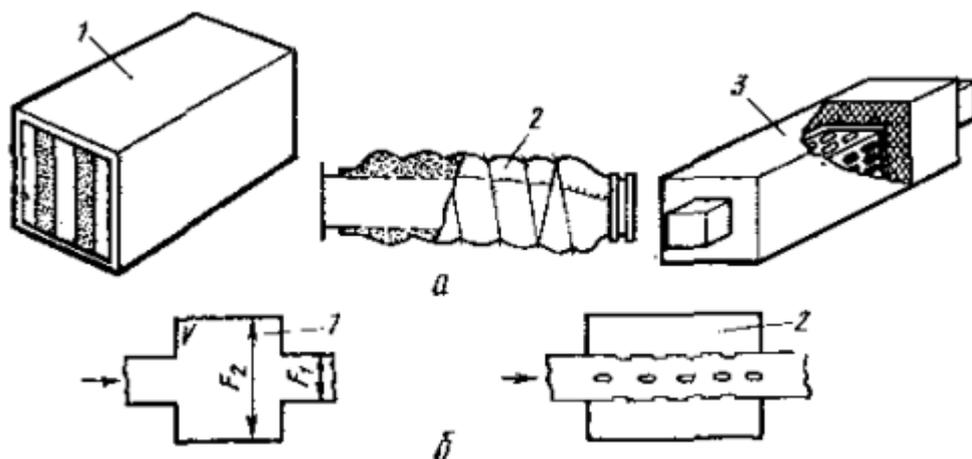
Схемы глушителей шума: а — активного типа (1 — пластинчатый; 2 — трубчатый круглого сечения; 3 — трубчатый прямоугольного сечения); б — реактивные (1 — камерный; 2 —
